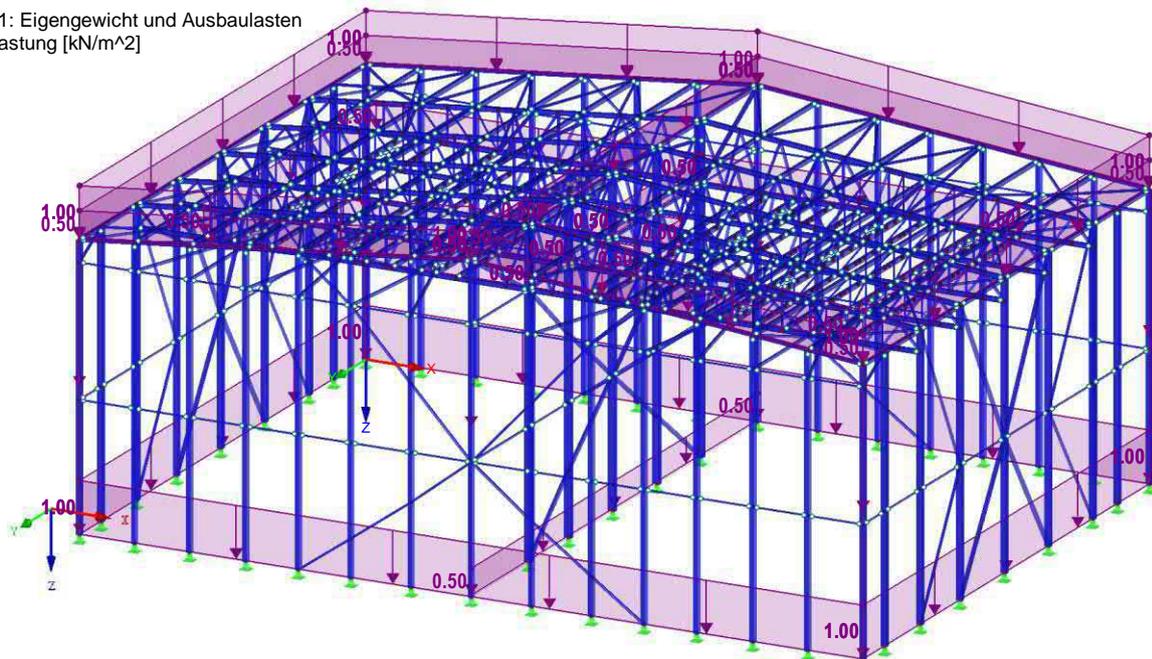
Lastfall 1: Eigengewicht und Ausbaulasten
